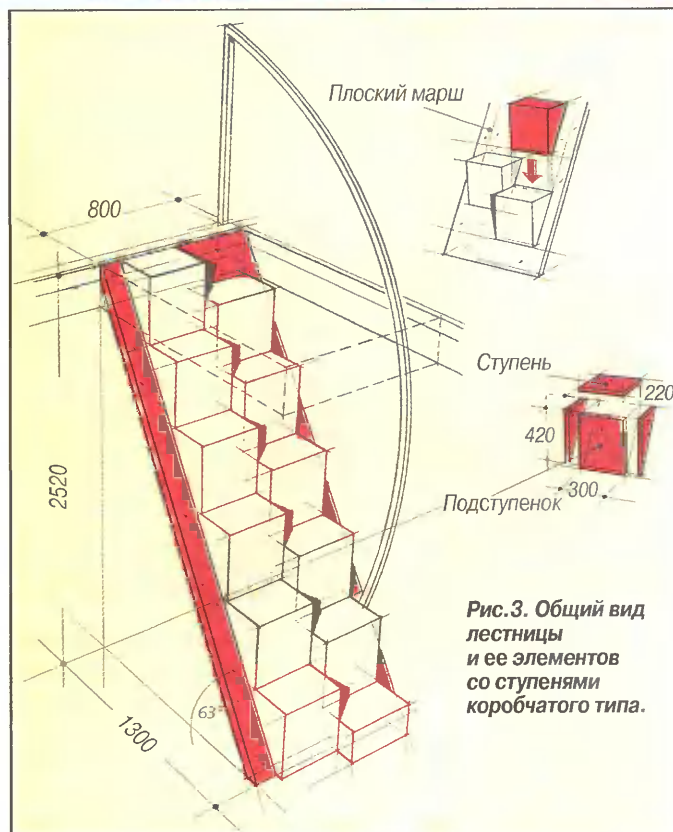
Общий вид лестницы и ее элементов коробчатого типа.
